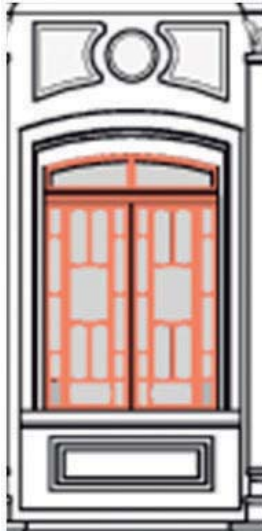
Detalle de antepecho, dintel y ventana de planta alta.
